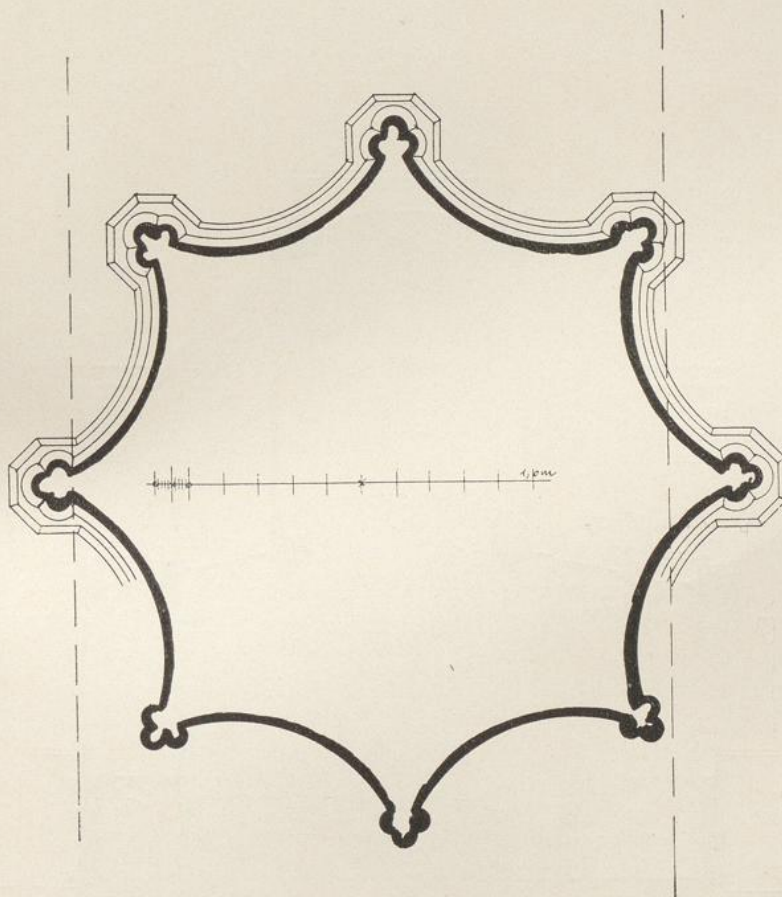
Nikolaikirche; Pfeilergrundriß.
